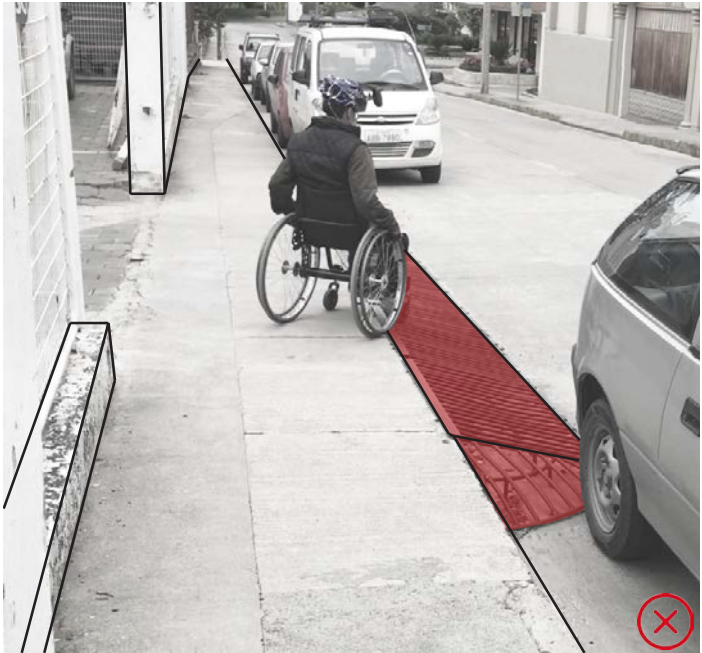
Estado actual. Rampa vivienda. Elaboración: Propia.
